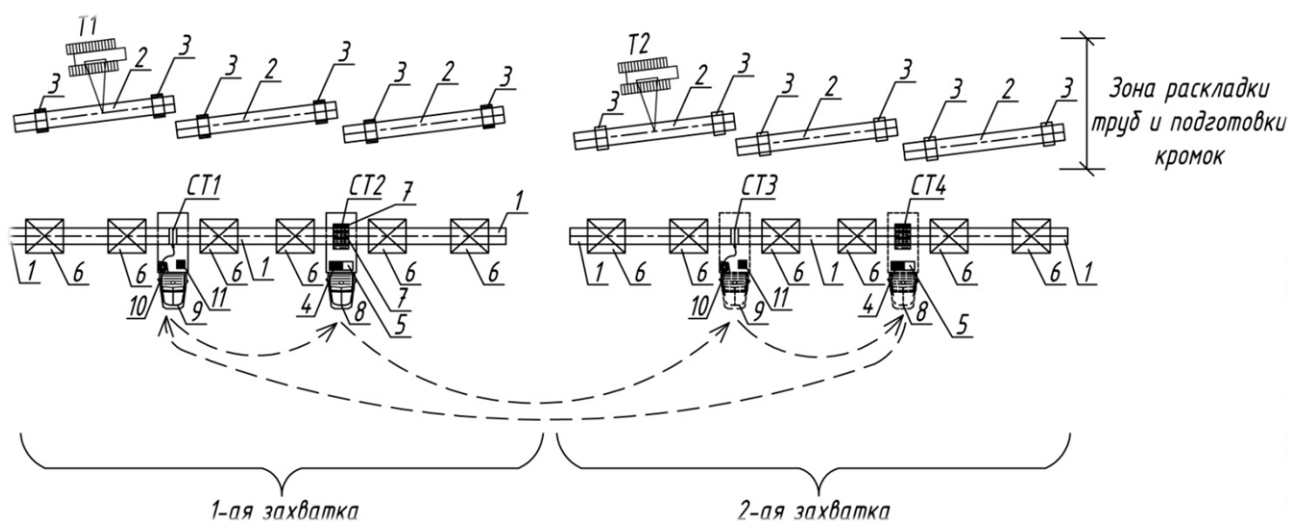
Технологическая схема проведения сварочно-монтажных работ при сборке плети магистрального трубопровода на приобъектной строительной базе с применением предлагаемых монтажных опор: 1-секции труб уложенные на монтажные опоры, 2-секции труб на которых выполняется подготовка кромок, 3- инвентарные опоры, 4- распределитель для управления монтажными опорами, 5- электрогенератор, 6 - монтажные опоры (пат.на ПМ №147232), 7- автоматическая орбитальная установка для монтажа магистрального трубопровода, 8, 9 - грузовые машины, 10 – газовый баллон, 11-изоляционный материал для нанесения на сварные стыки магистральных трубопроводов, Т1, Т2-трубукладчики, СТ1, СТ2, СТ3, СТ4- сварные стыки –первый, - второй, - третий, -четвертый соответственно
